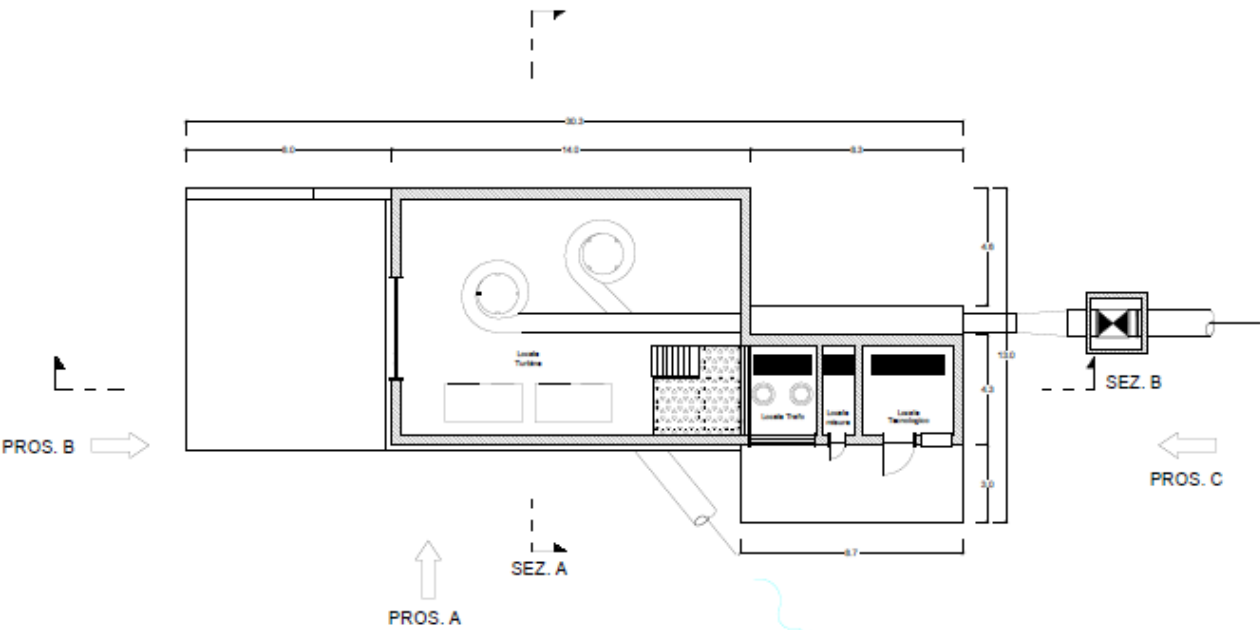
Pianta di progetto centrale idroelettrica di Mollieres
